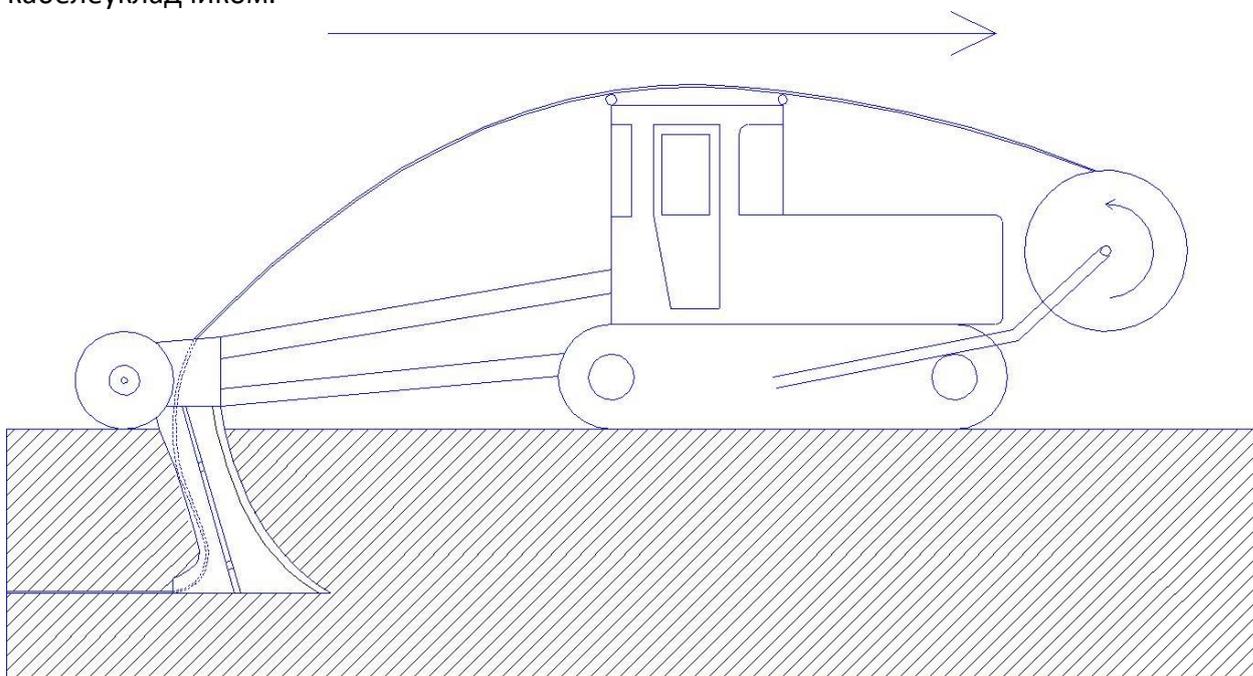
Прокладка оптического кабеля в грунт кабелеукладчиком
